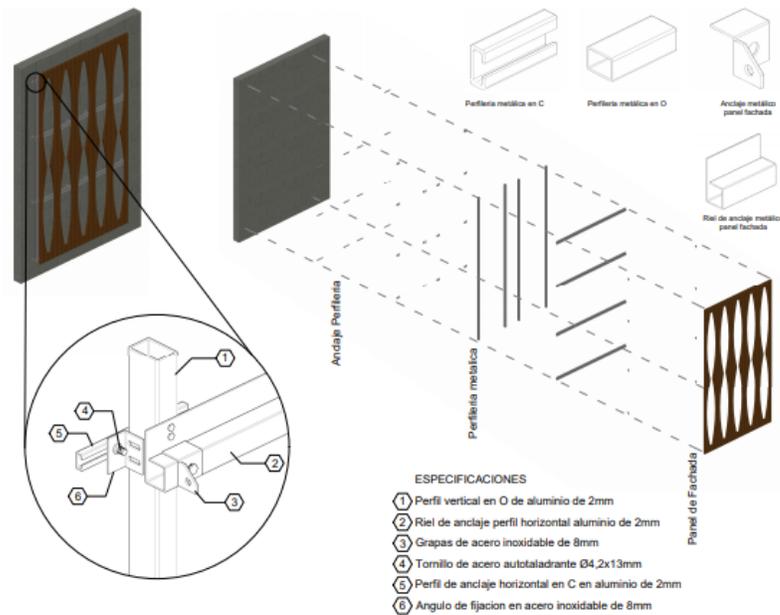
Detalle anclaje Fachada. Elaboración Propia
